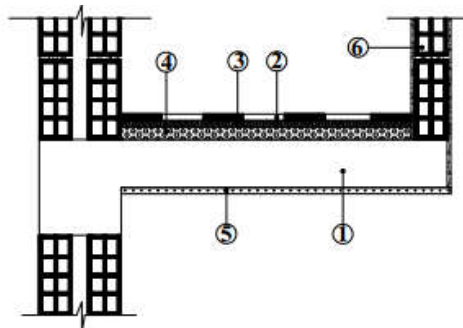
Coupe transversale du plancher d'étage courant.
